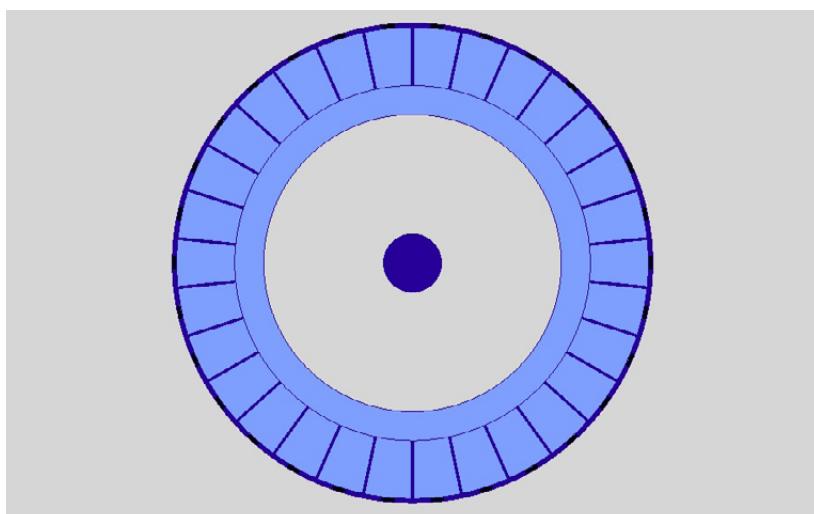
Planta esquemática del tipo panóptico. El autor. 2024. 2024. CC BY-SA 4. 0.
